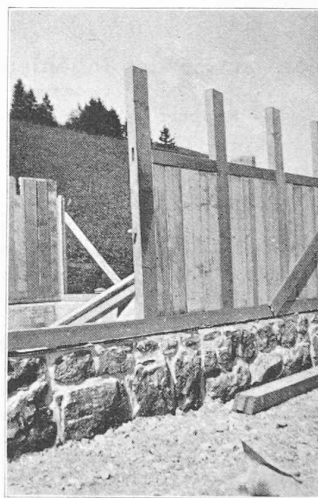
Principe de la paroi : sablière, madriers, cheville, etc.
